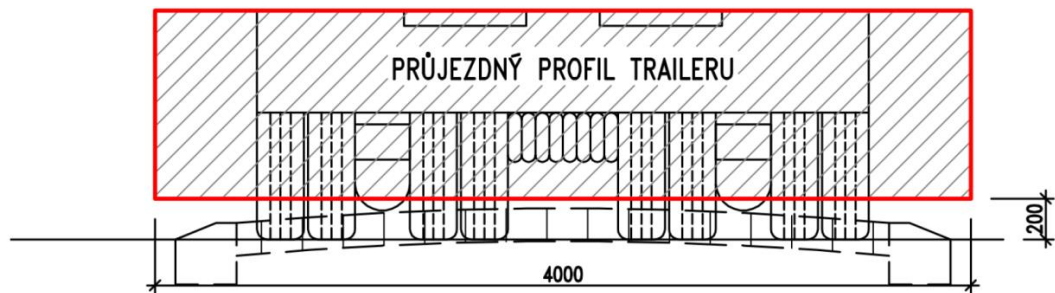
Ověření průjezdu soupravy okružní křižovatkou
